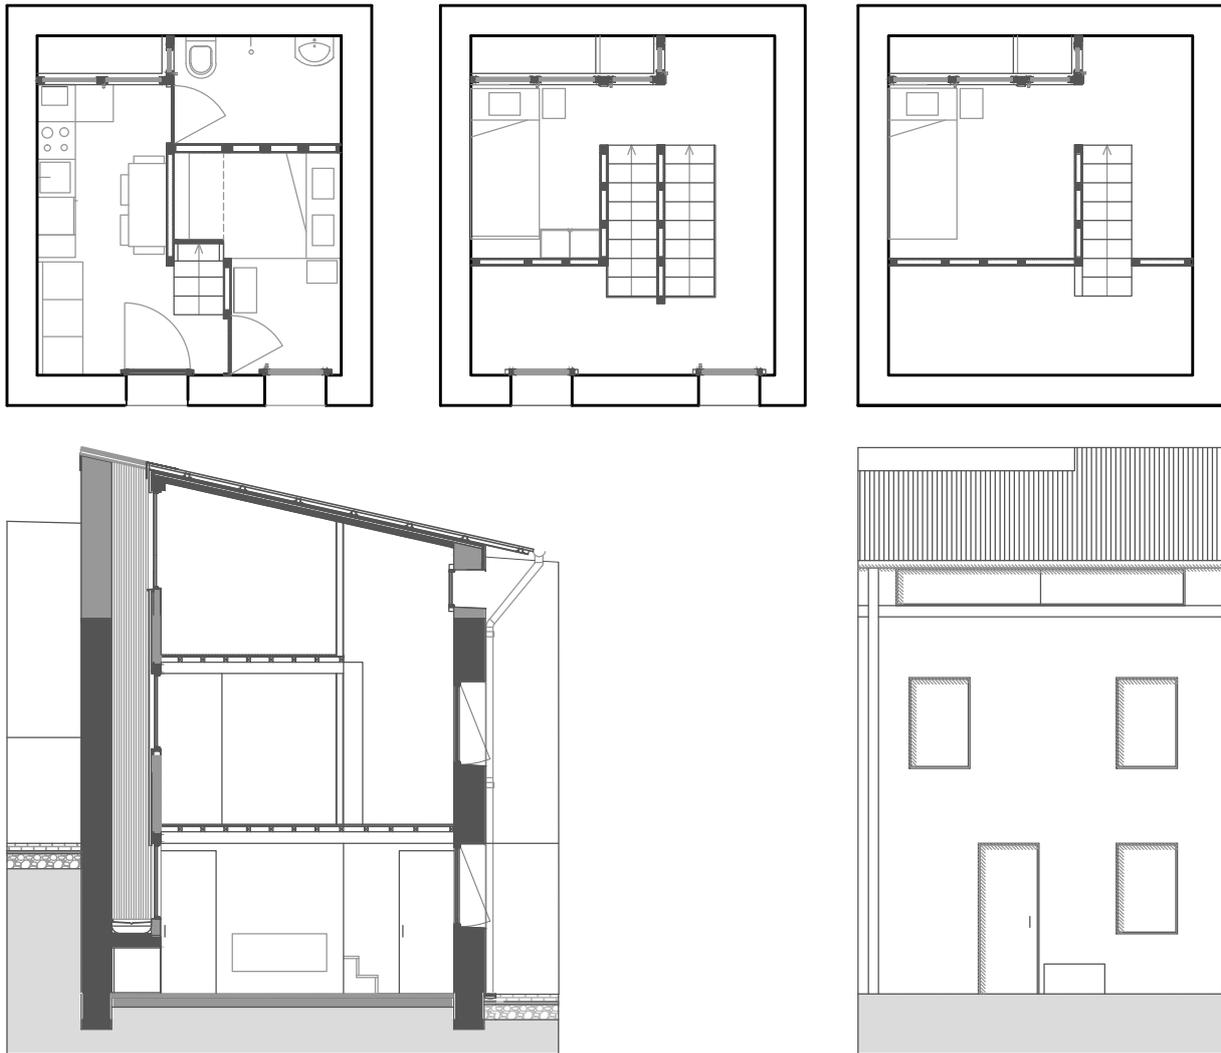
Plantas, Secções e Alçado Tipologia A2 esc. 1:100
